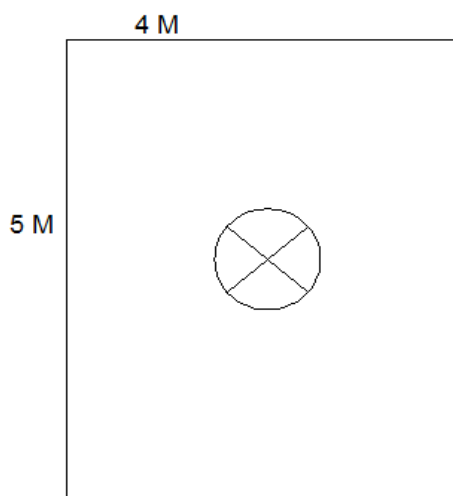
Denah Titik Pengukuran Ruang Perpustakaan
